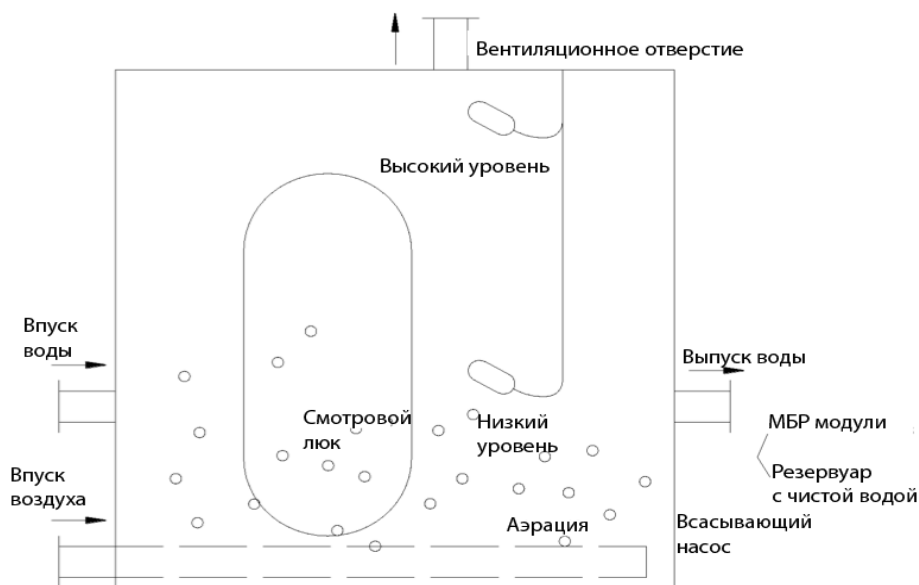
Схема устройства резервуара для сбора сточных вод
